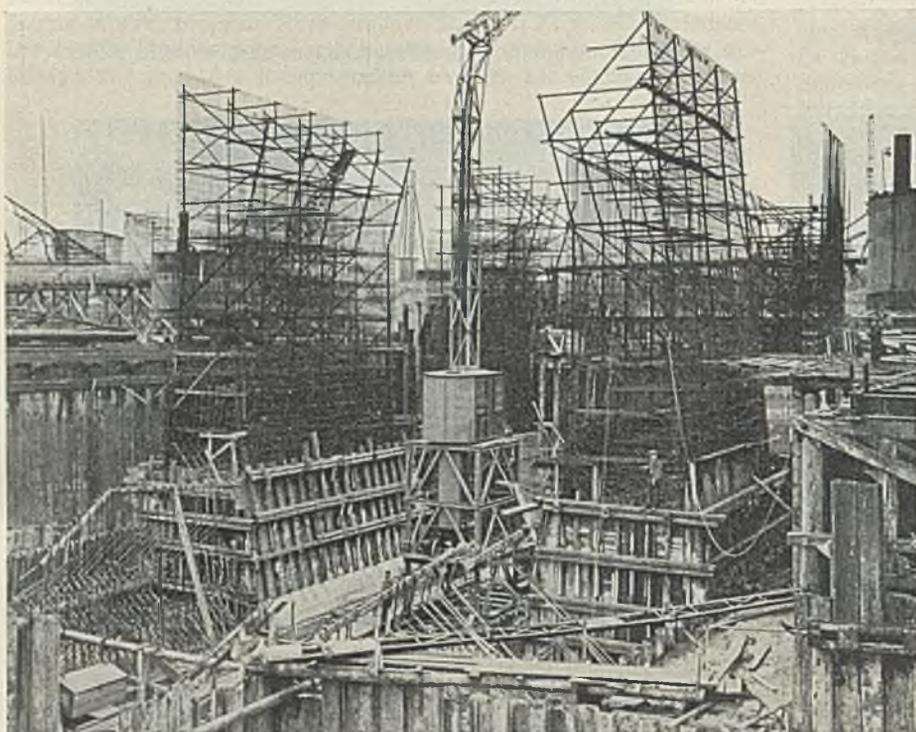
Eiserne Schalgerüste für die Torkammer am Binnenhaupt.
